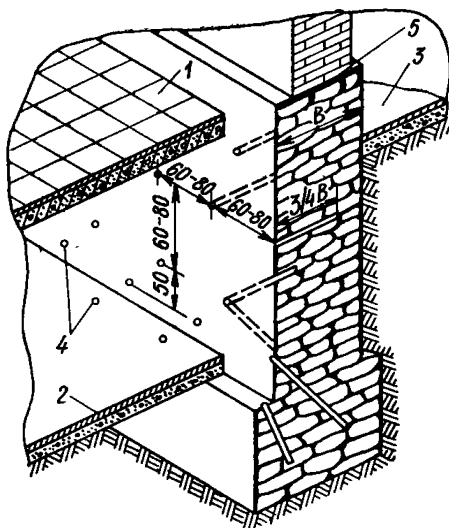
Схема расположения отверстий для иньекции при химическом методе укрепления кладки фундамента
